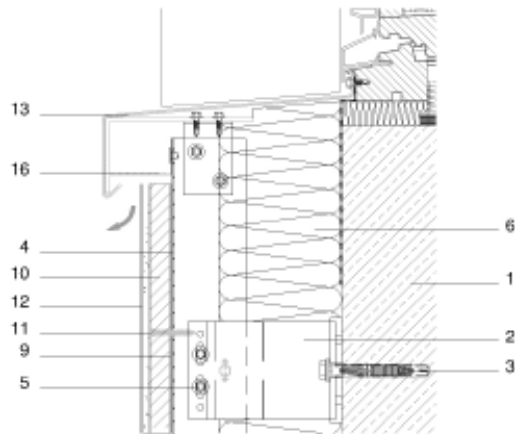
Detalhe construtivo de peitoril de janela [78].
